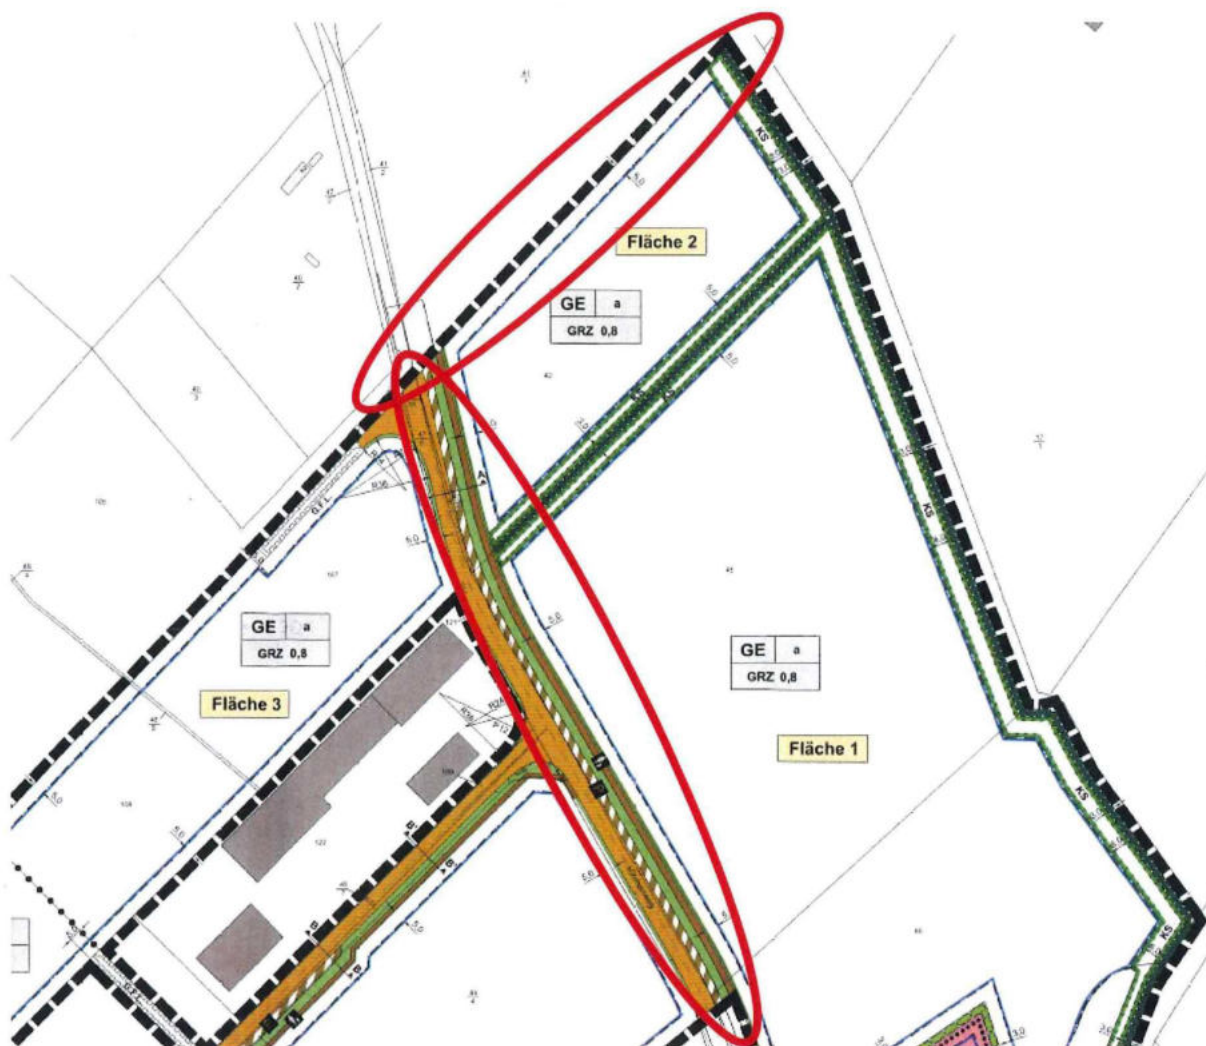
Ausschnitt Planzeichnung - B-Plan Nr. 4.2 Stand: Satzungsbeschluss Nov. 2018
